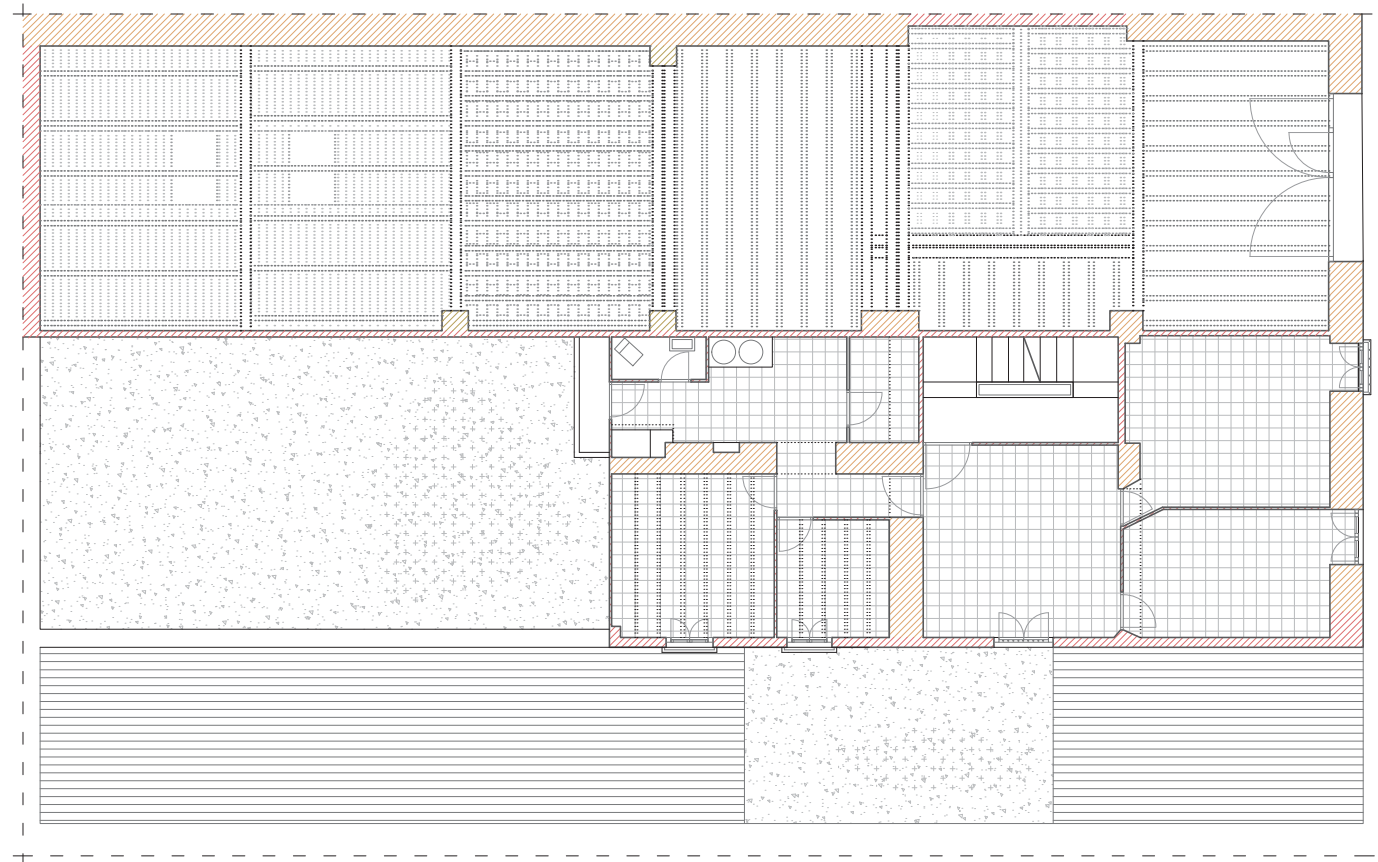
Planta primera (Fuente: elaboración propia)
